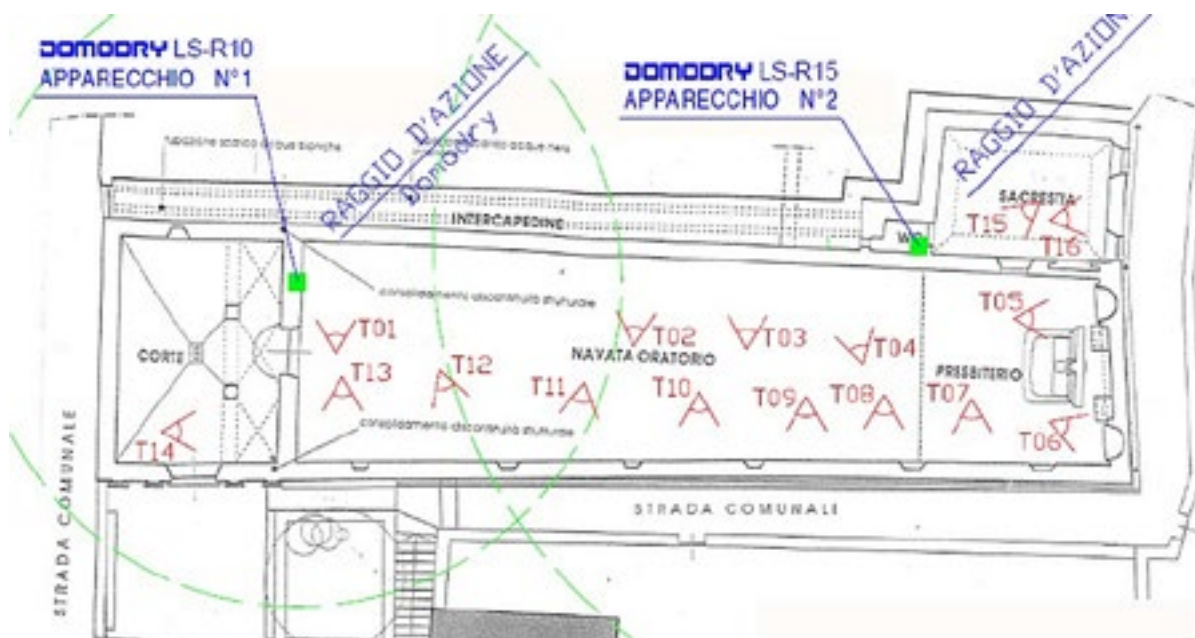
Schema dell'impianto Domodry con ubicazione in pianta delle prove effettuate (termografie all'infrarosso).
